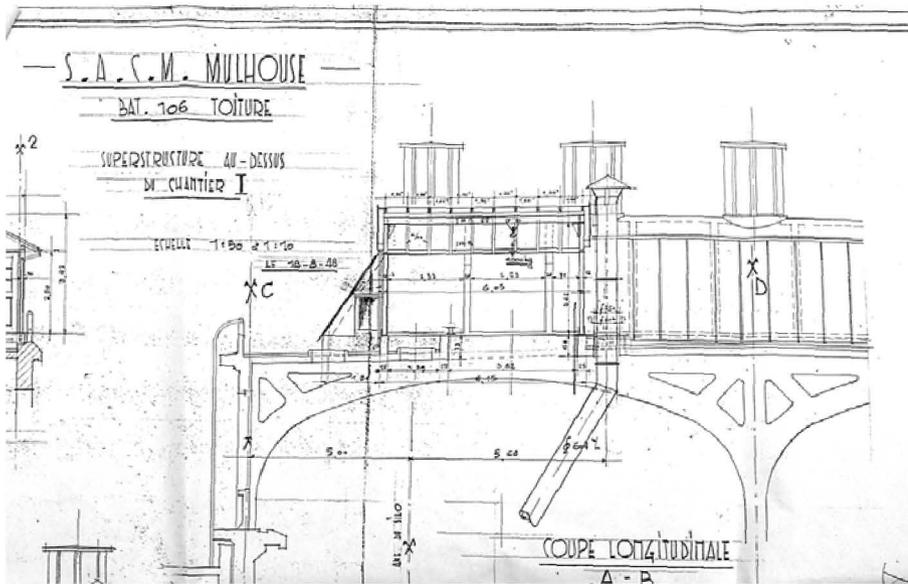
제련소 건물의 남아있던 도면(detail drawing)
